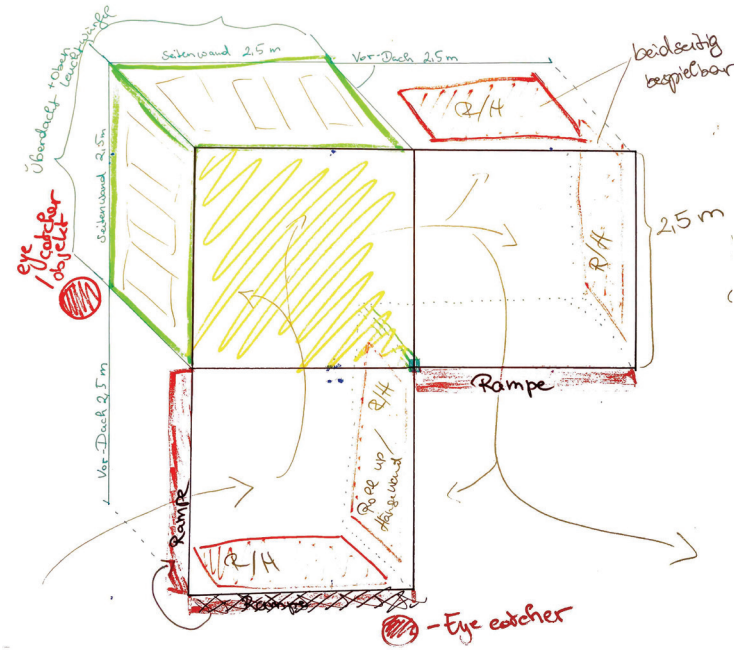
Grundriss-Skizze, Leichtbau Container, Variante 1
